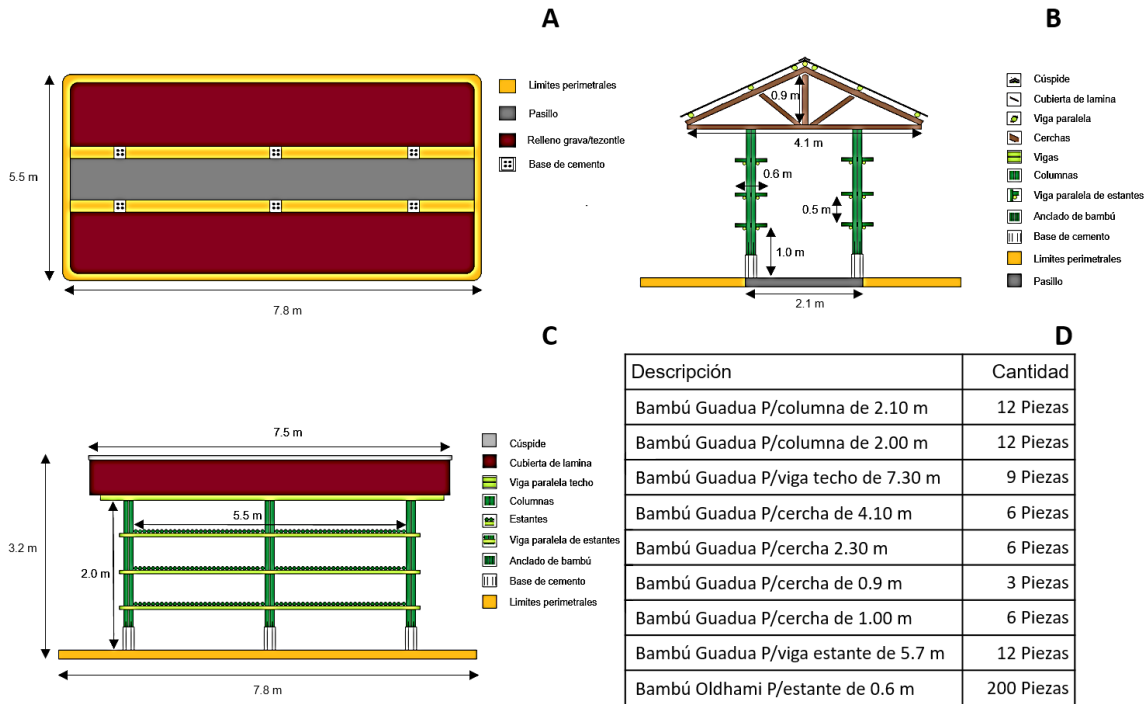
A: Vista aérea de piso. B: Vista lateral de piso, estructura de soporte tipo Pratt, cubierta del techo, columnas y estantes. C: Vista frontal de piso, columnas, estantes y techo. D: Longitud de las piezas de bambú para estructura de soporte tipo Pratt y estantes. Fuente: Elaboración propia.
